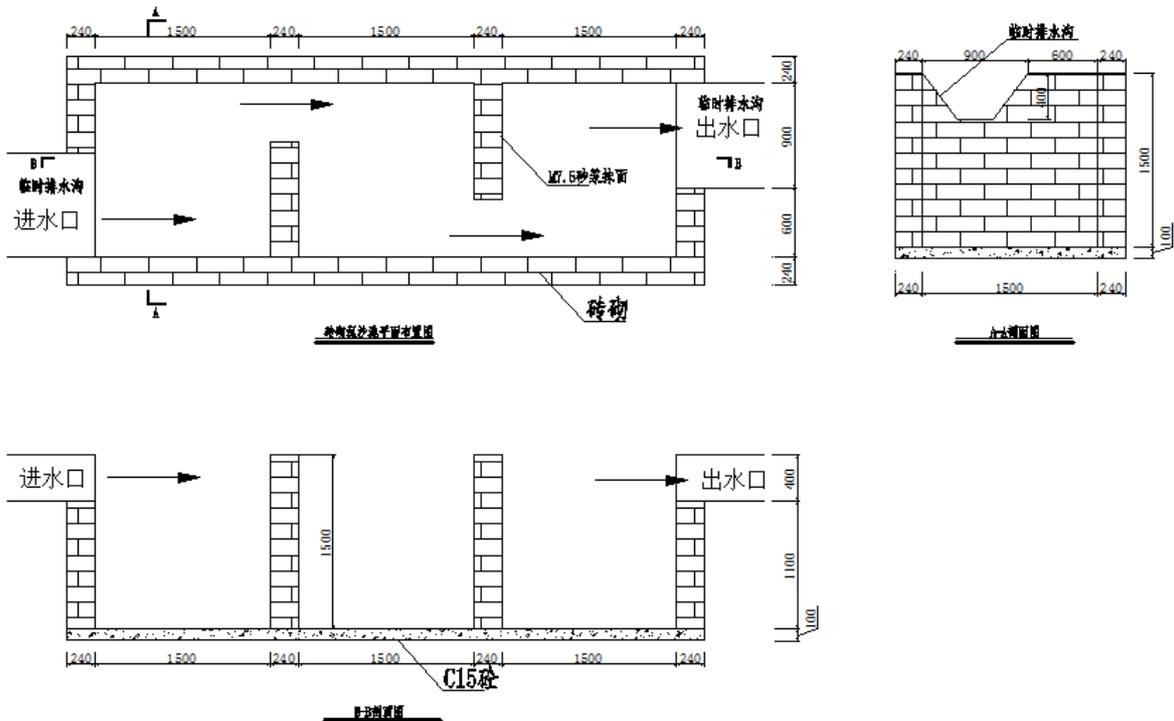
砖砌沉砂池典型设计断面图 单位：mm
